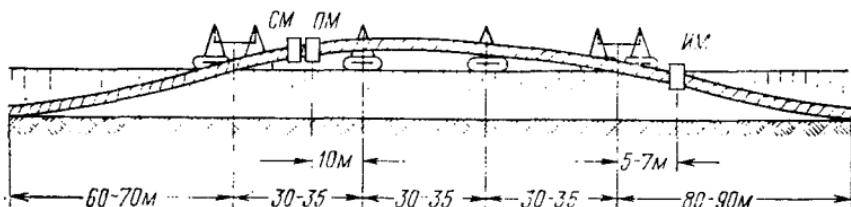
Схема расстановки трубоукладчиков при поднятии трубопровода, его изоляции и укладке
